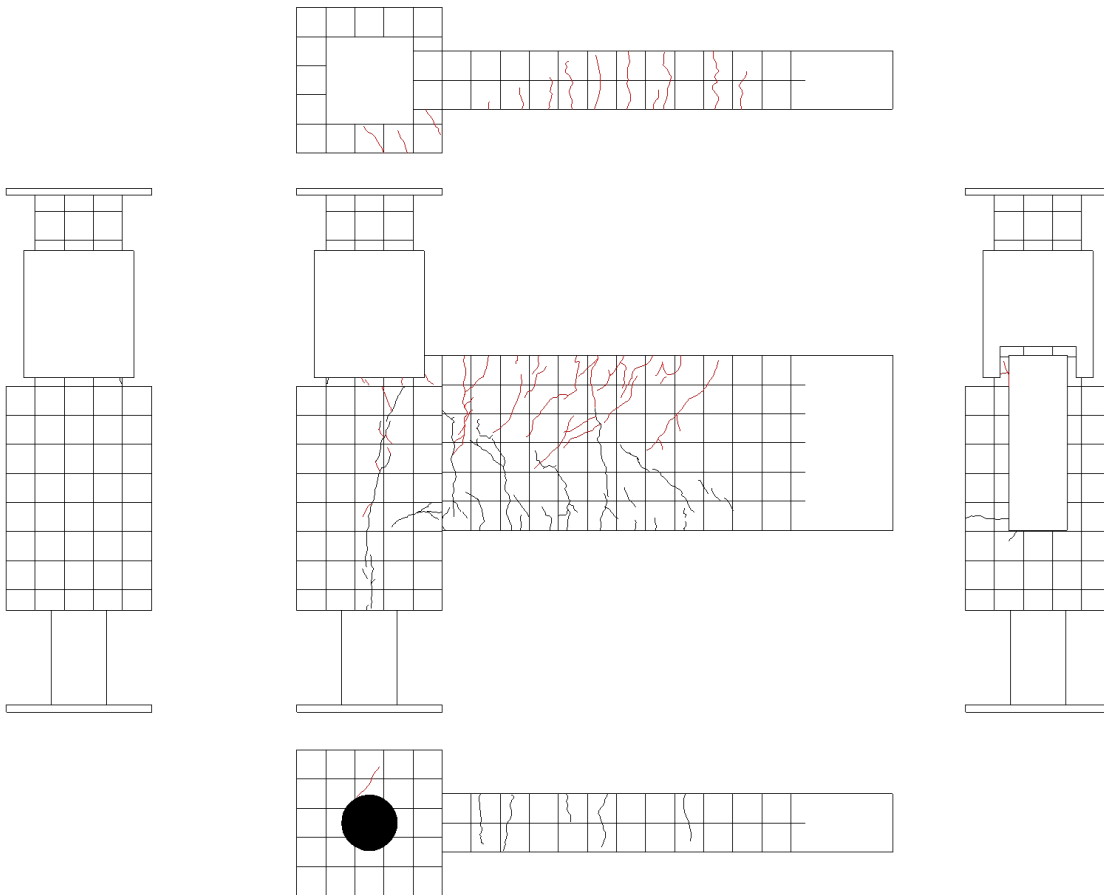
3. 57 試験体 A-2 ひび割れ状況 (40Cycle)
